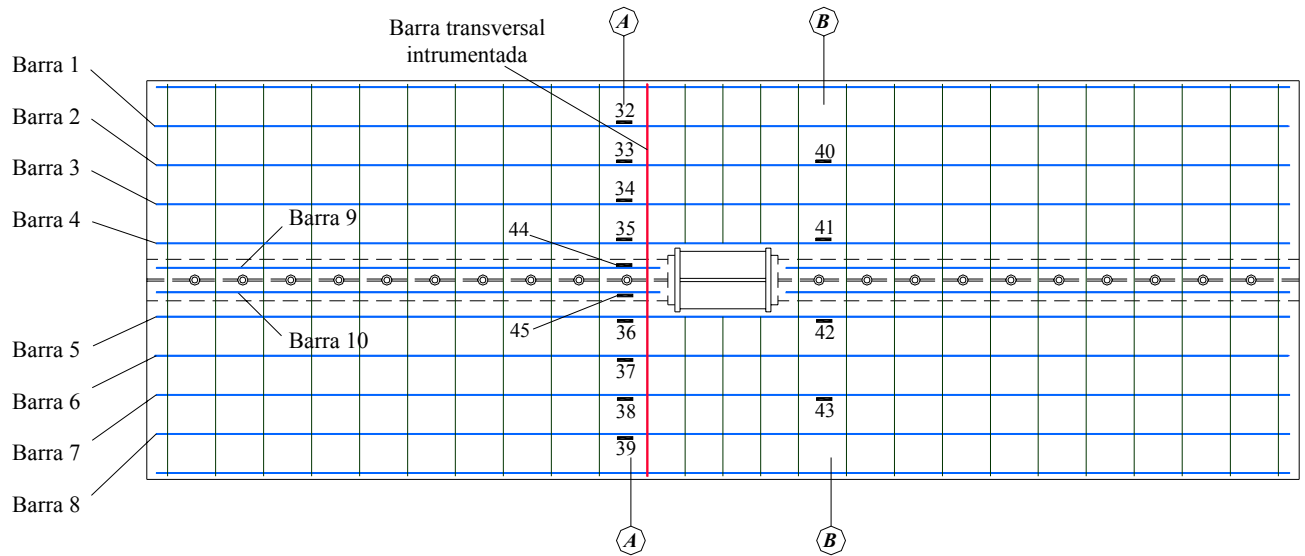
Numeração dos extensômetros das barras da armadura de um modelo cruciforme
